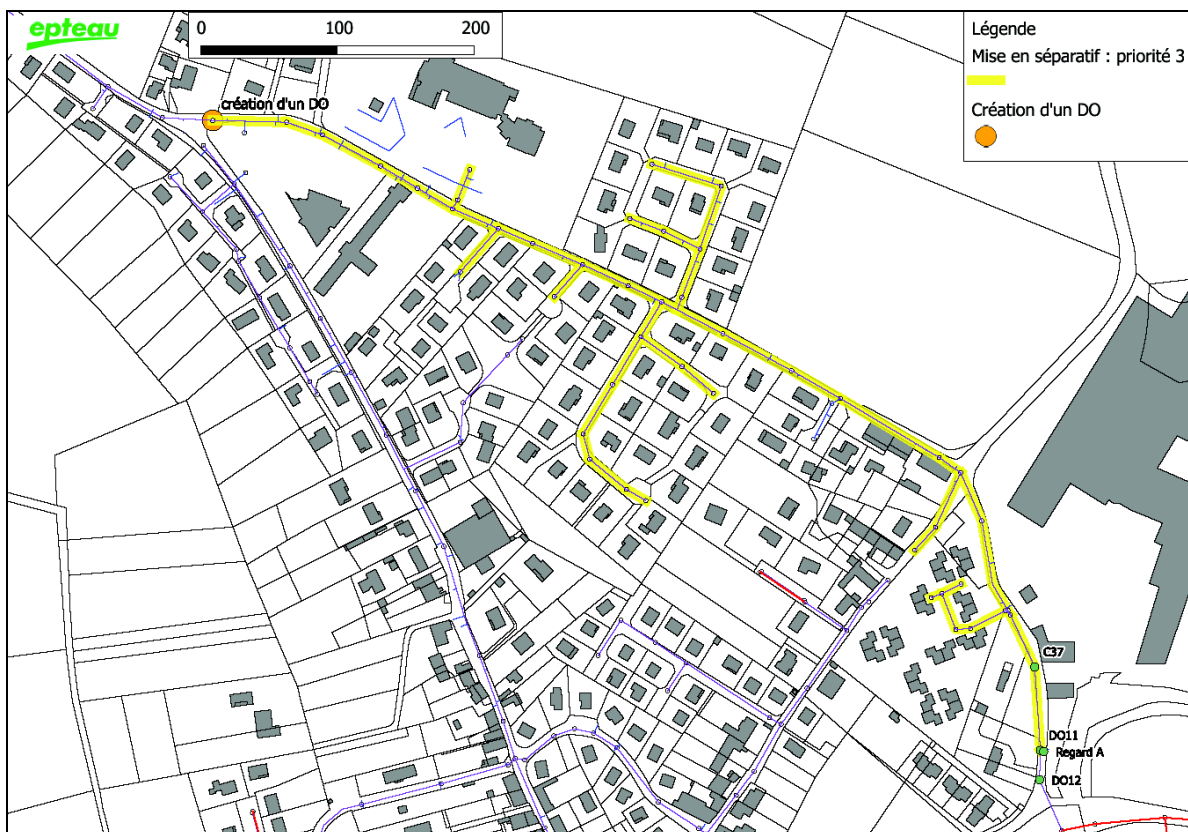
Chavanoz : localisation des travaux proposés, secteur amont DO35
